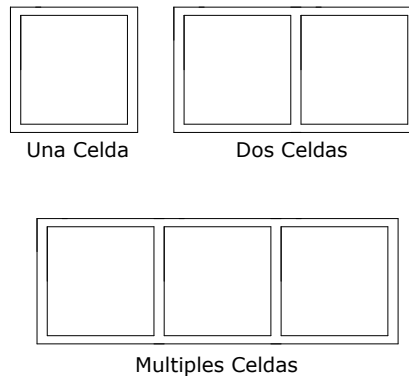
Alcantarillas cajón de hormigón armado
